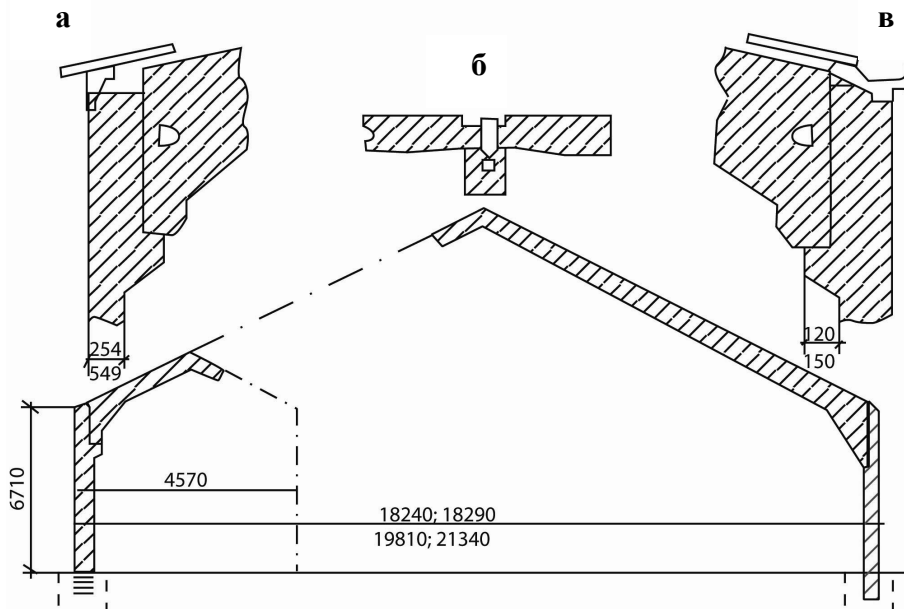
Схема однопролітної залізобетонної рами /Великобританія/
